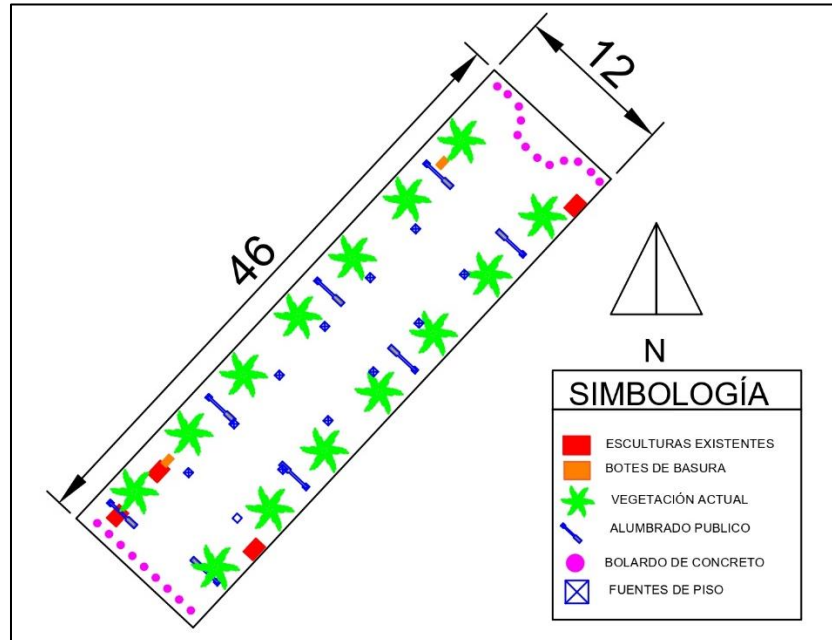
Vista en planta del estado actual de la calle 1 entre avenidas 1 y 2. Elaboró: Erick Efraín Jiménez, diciembre 2022.
